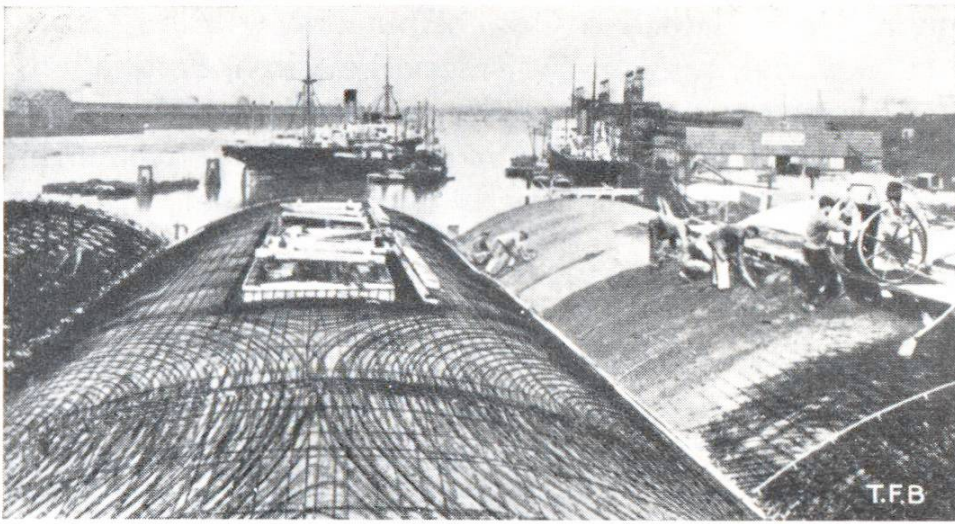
Flache Schalengewölbe im Bau. Links Armierung. Rechts Aufbringen des Betons.
